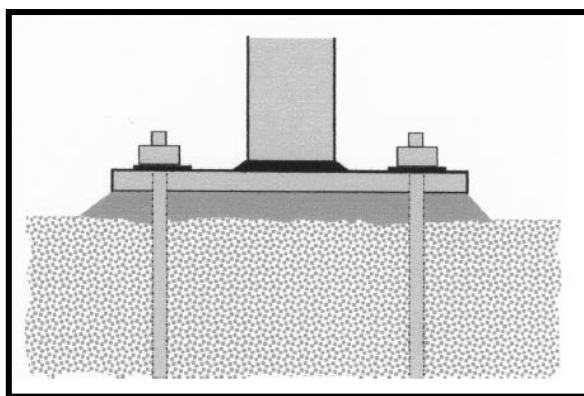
Assentamento de chapas metálicas nas fundações [25]
